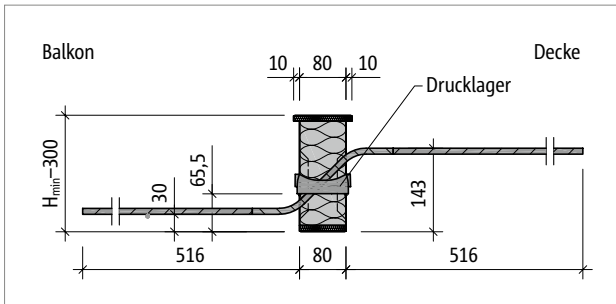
Schöck Isokorb® T Typ QL-V4: Produktschnitt
